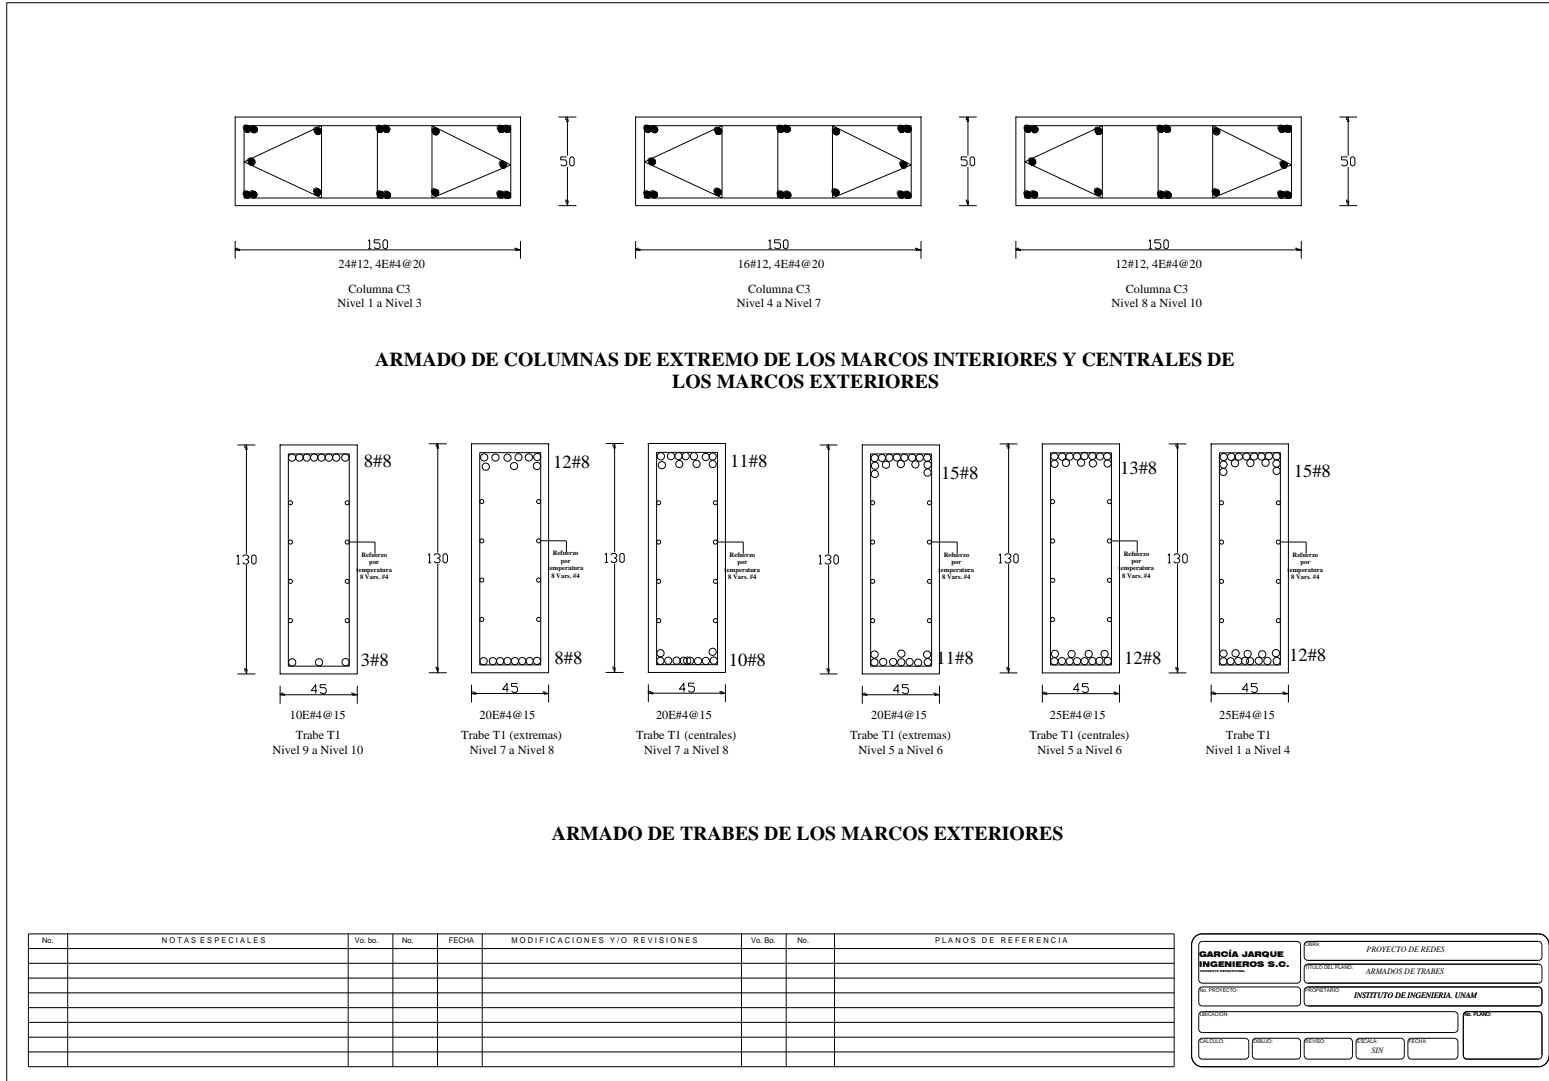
Detalles estructurales del edificio de 10 niveles diseñado con el RCDF-04
